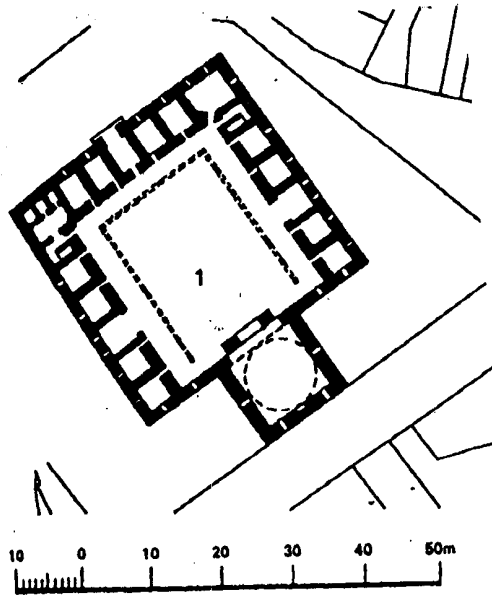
مسقط أفقي للمدرسة المحمودية بالحياتية بالقاهرة
